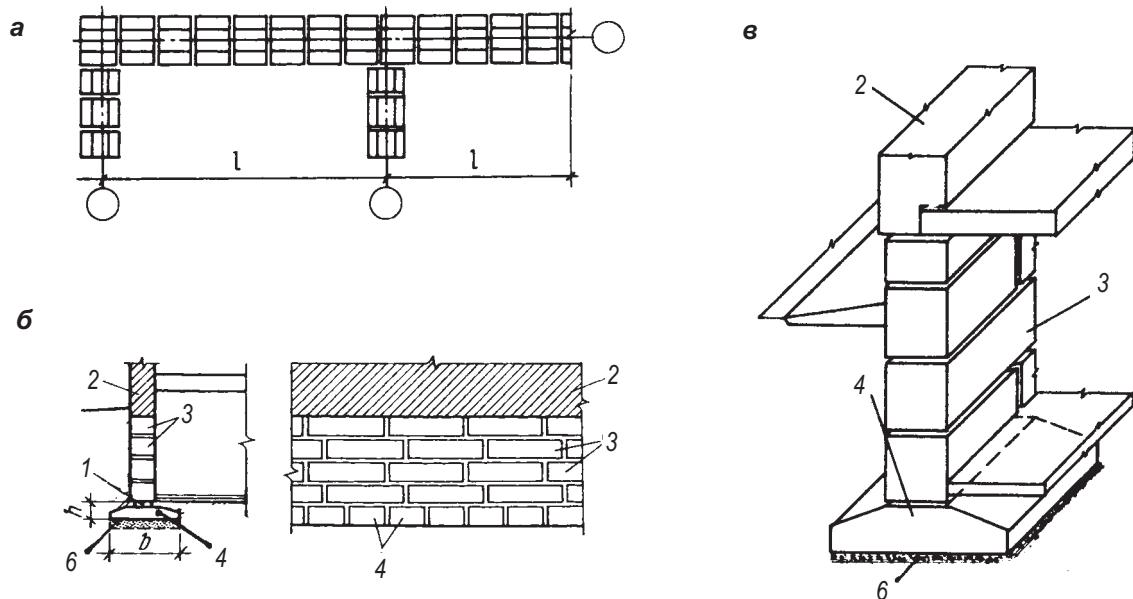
Стрічковий збірний фундамент із великих блоків:
